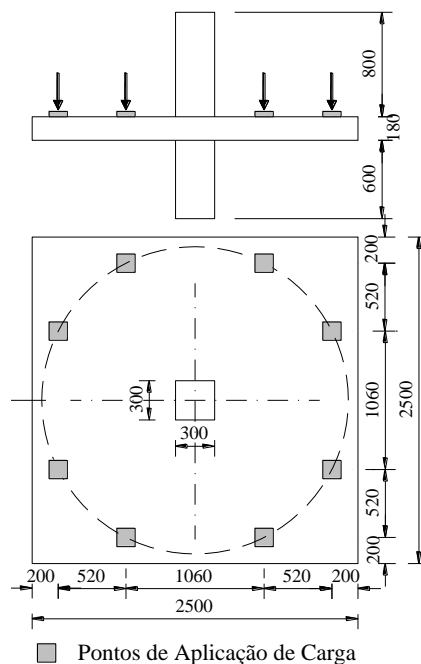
Dimensões das Ligações Laje-Pilar
